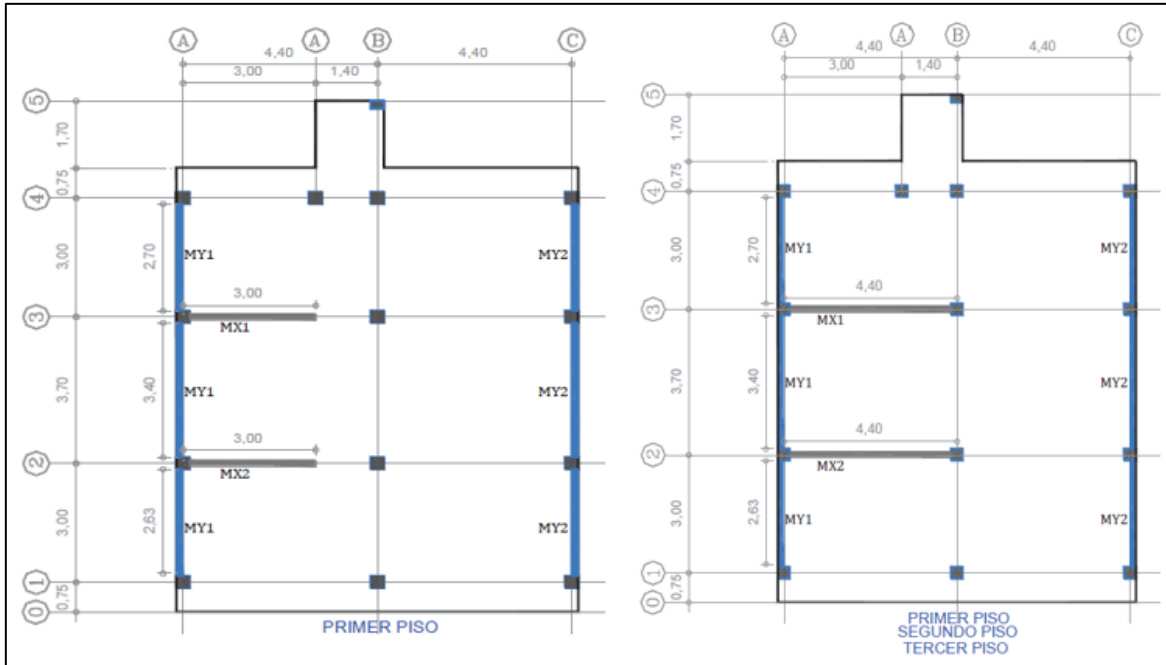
Vista en planta de los muros a enchapar en la alternativa 1 (izquierda) y alternativa 2 (derecha).
